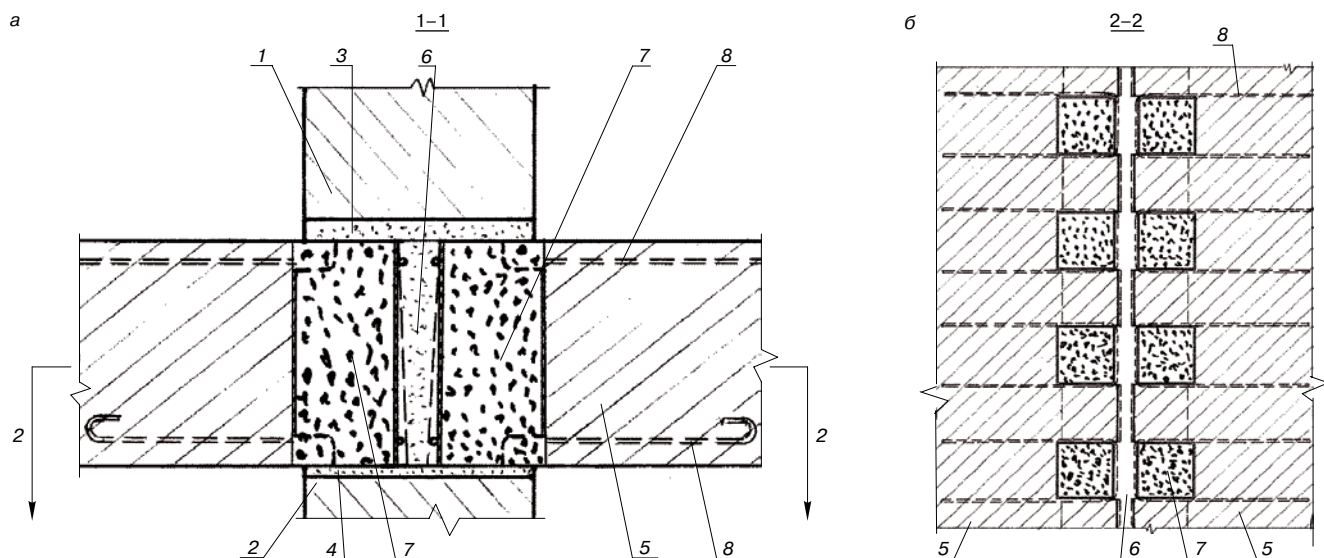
Платформенный стык с трубобетонными элементами в крупнопанельном здании между внутренними стенами из тяжелого бетона с перекрытиями из легкого бетона: а – поперечное сечение 1–1; б – поперечное сечение 2–2
